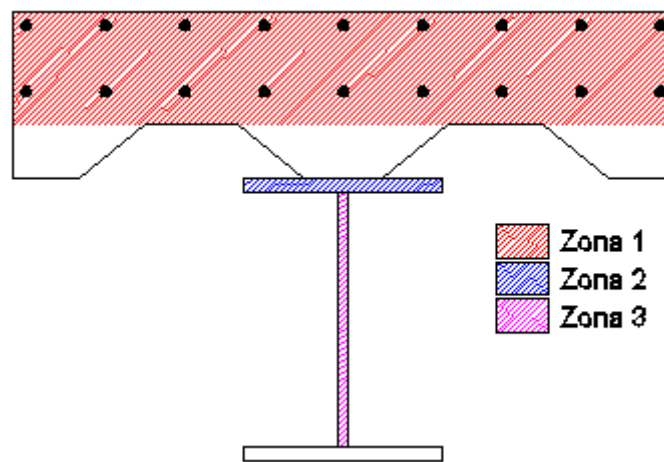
Localizações do eixo neutro para secções sem perfil metálico parcialmente envolvido em betão (M+).
